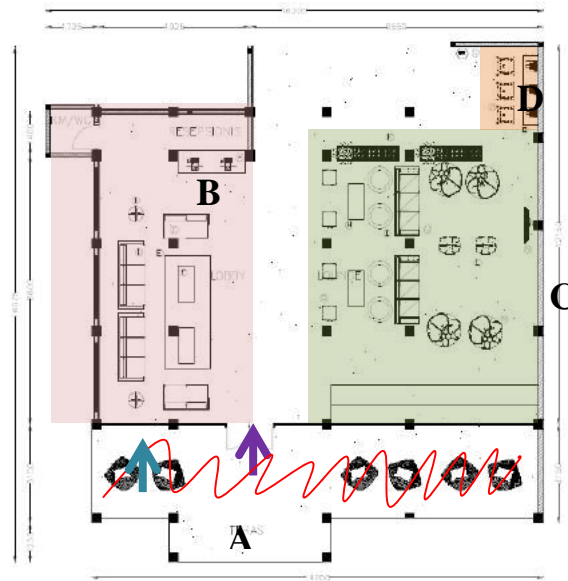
Gambar Denah Layout Ruang Terpilih 1
